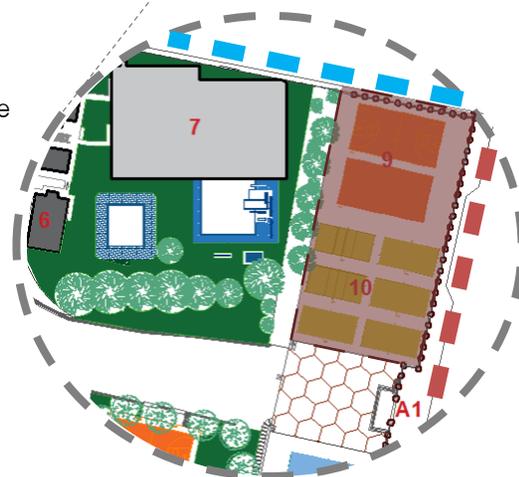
Centro Deportivo Ejercito de la Revolución. Muestra la localización exacta del terreno dentro del Centro Deportivo. Fuente: Plan Maestro del CEDER, AutoCAD. Consultado el 30 de noviembre del 2016.
